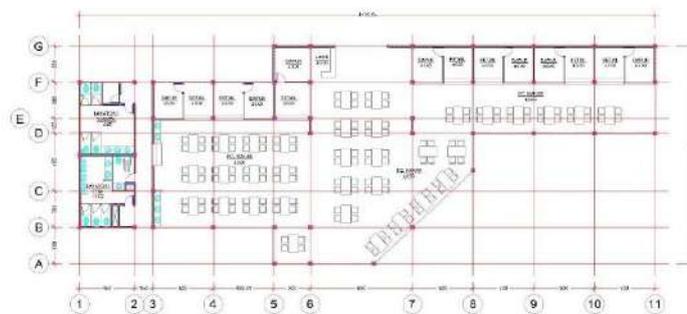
Denah Lantai 1 dan 2 Gedung Workshop dan Sanggar
